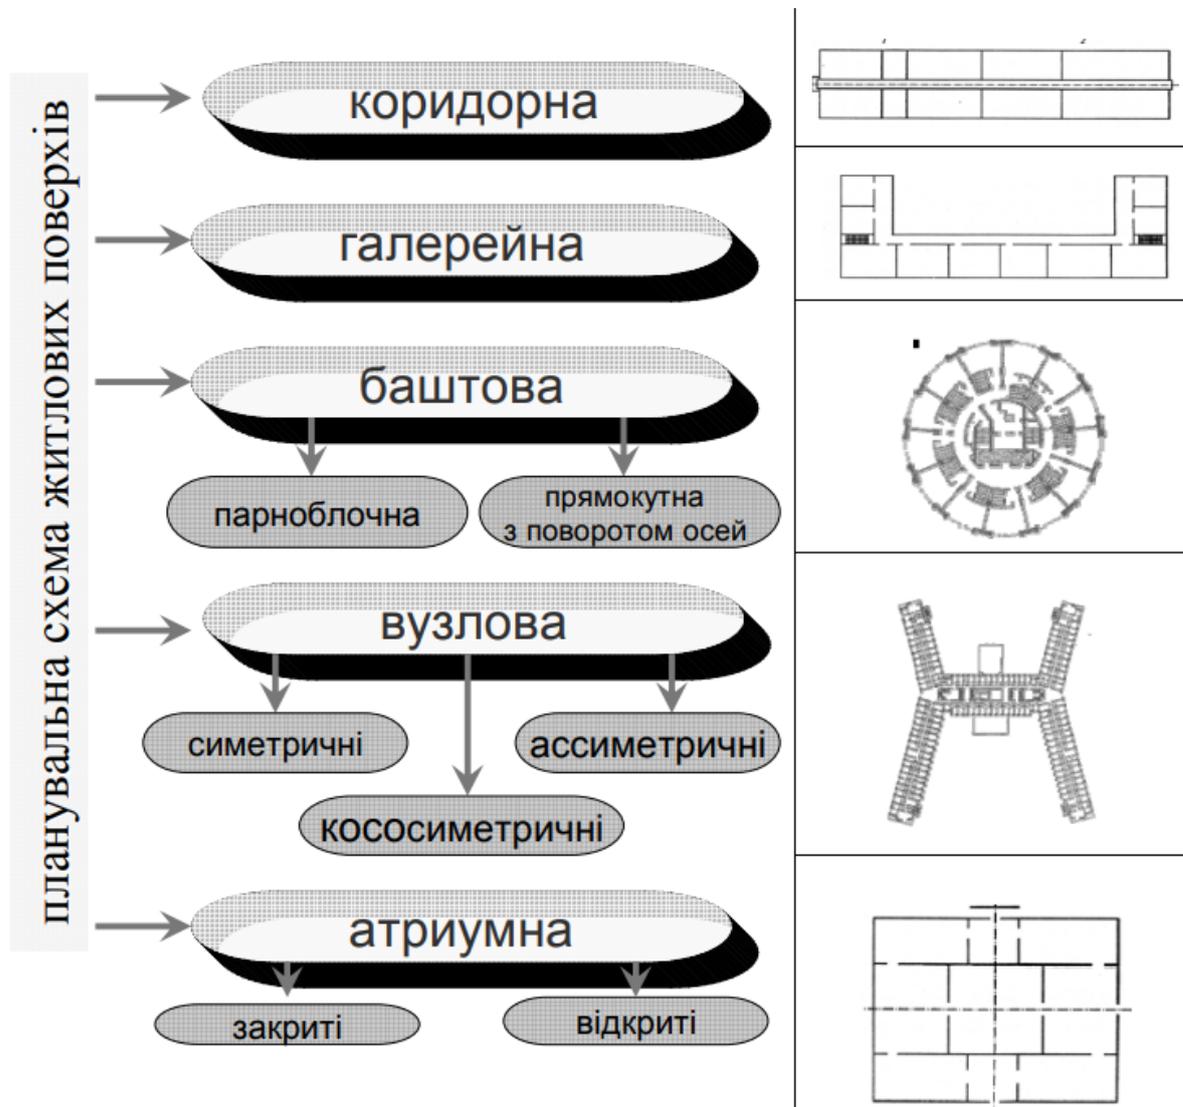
Прийоми планувань будівель готельних підприємств
